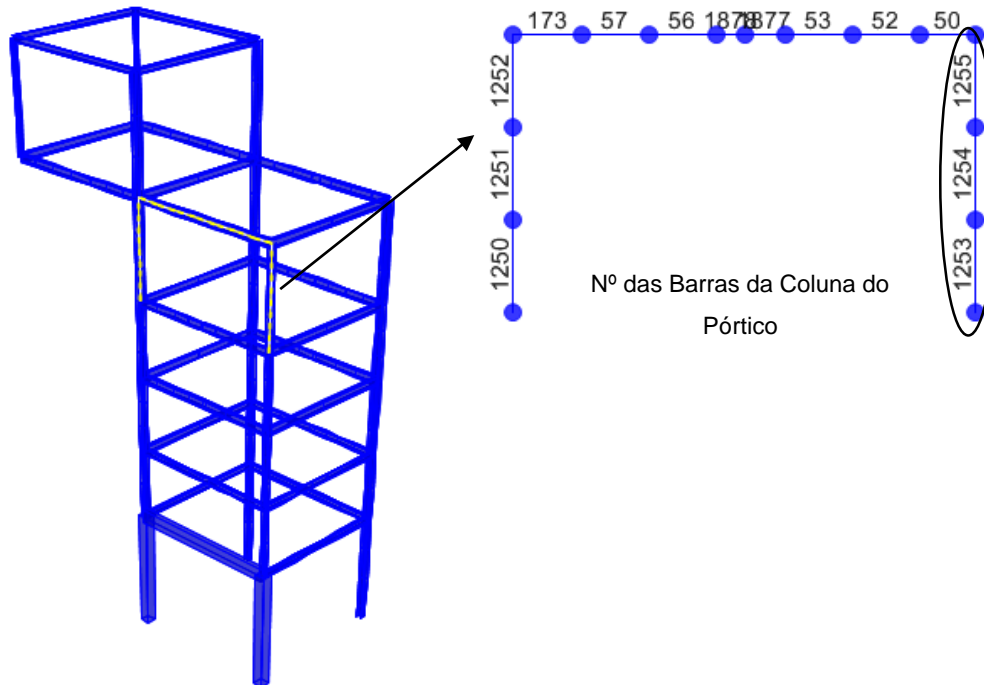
Identificação das Barras que constituem a Coluna do Pórtico.
